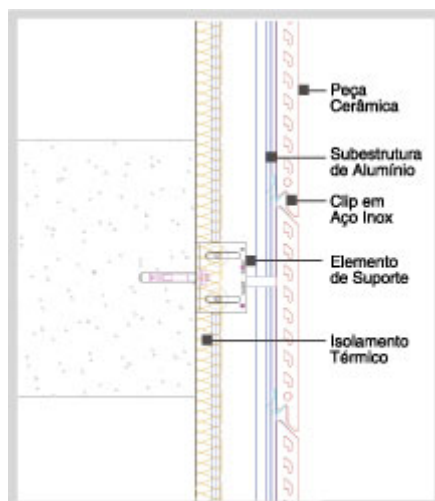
Aplicação da fachada ventilada – Detalhe vertical da solução [47]
